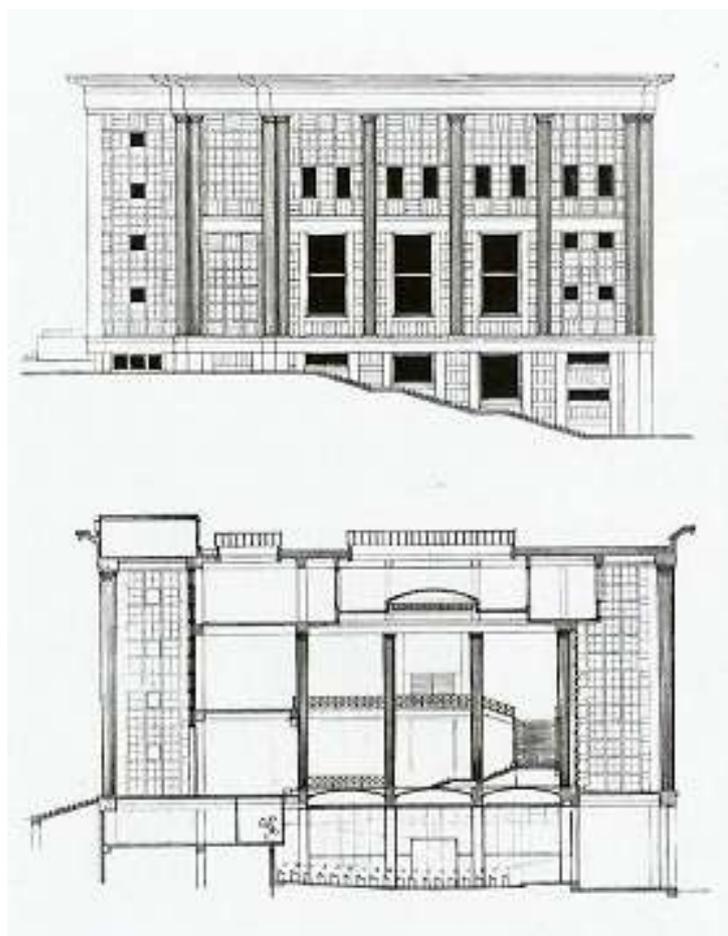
Elevação lateral e corte do hall de entrada do Museu de Belas-artes de São Paulo.
